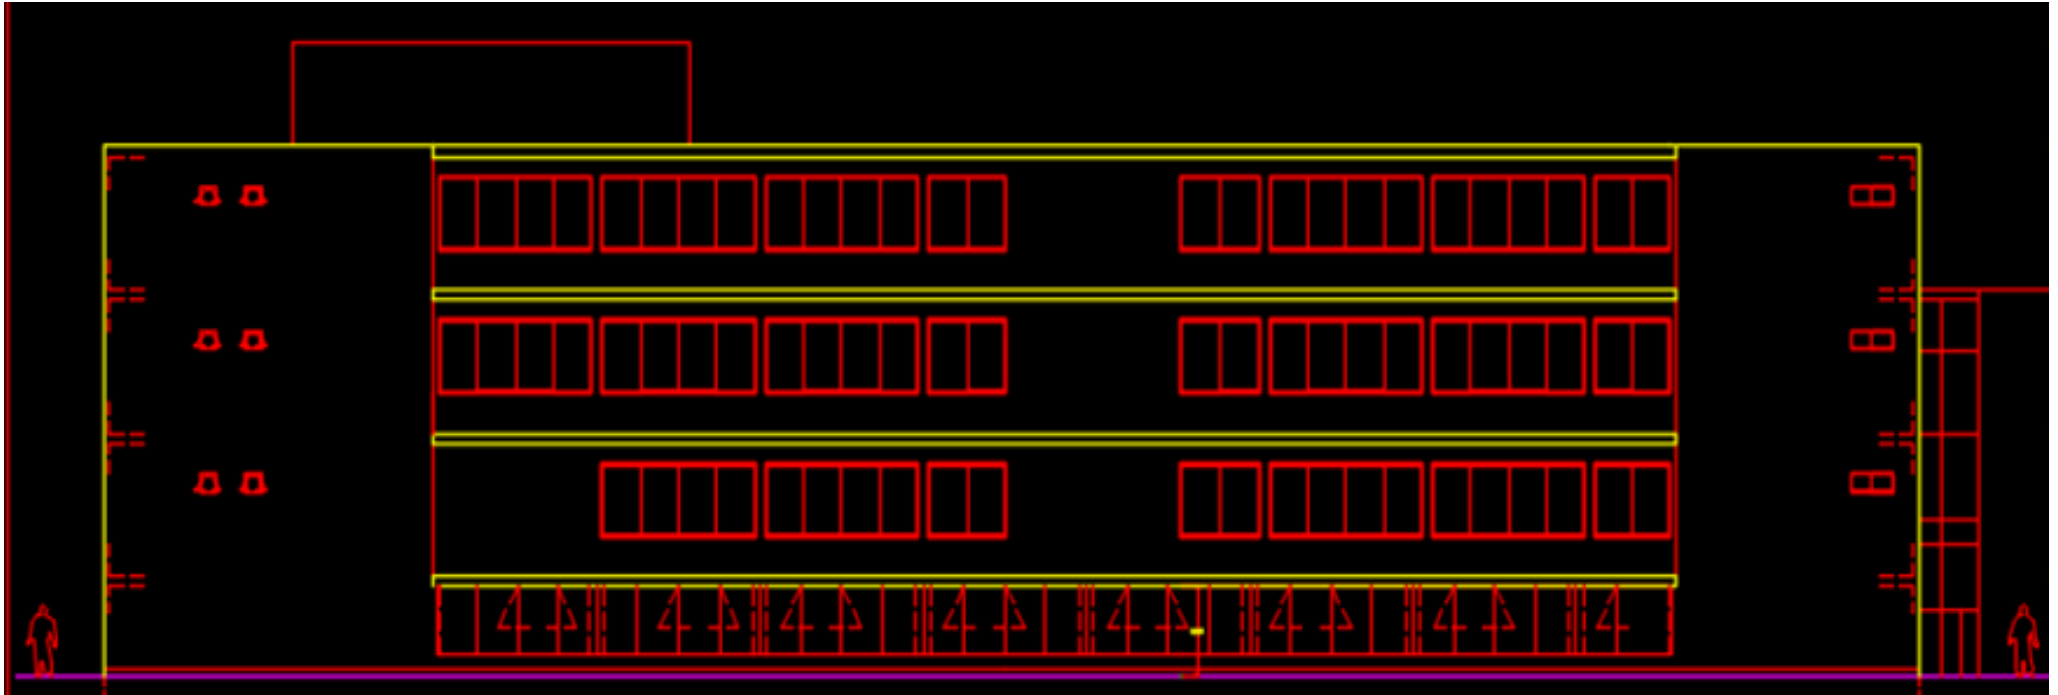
Elevación – Infraestructura del Pabellón de Laboratorios
